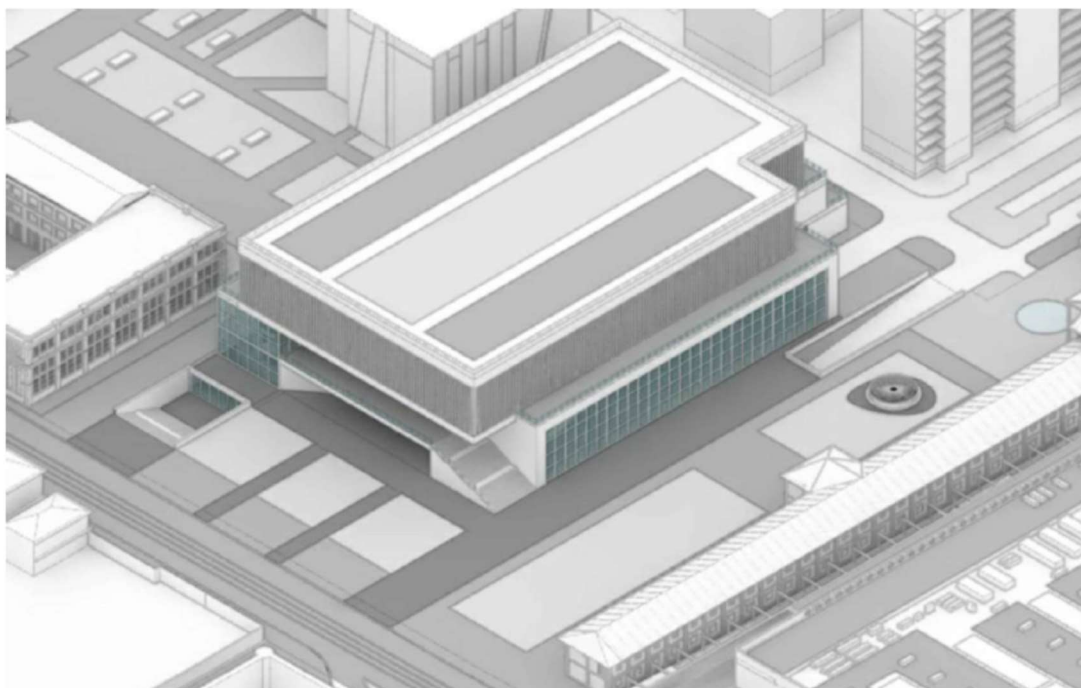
Vista indicativa del centro congressi (Elaborazione Studio Rolla)
